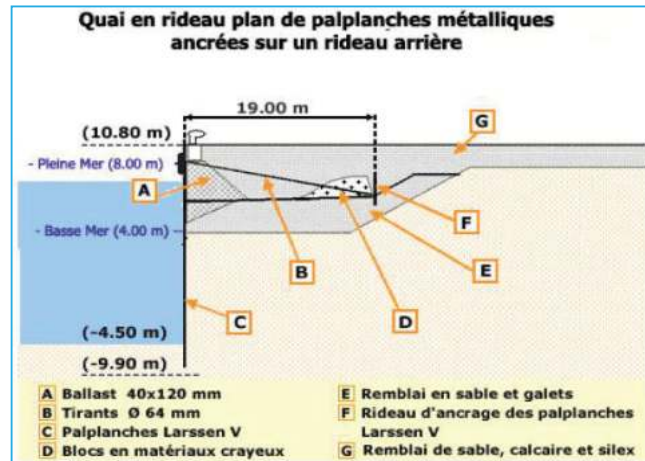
Quai en rideau plan de palplanches métalliques ancrées
